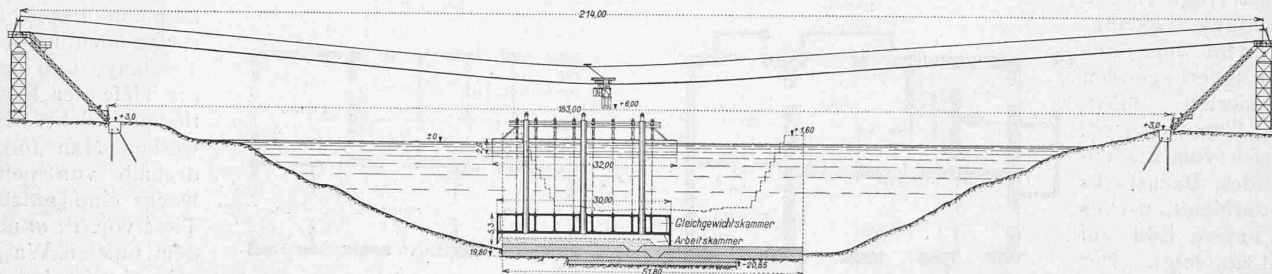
Querschnitt durch die Baugrube, Längsschnitt durch den beweglichen Caisson. — Masstab 1 : 1200.
